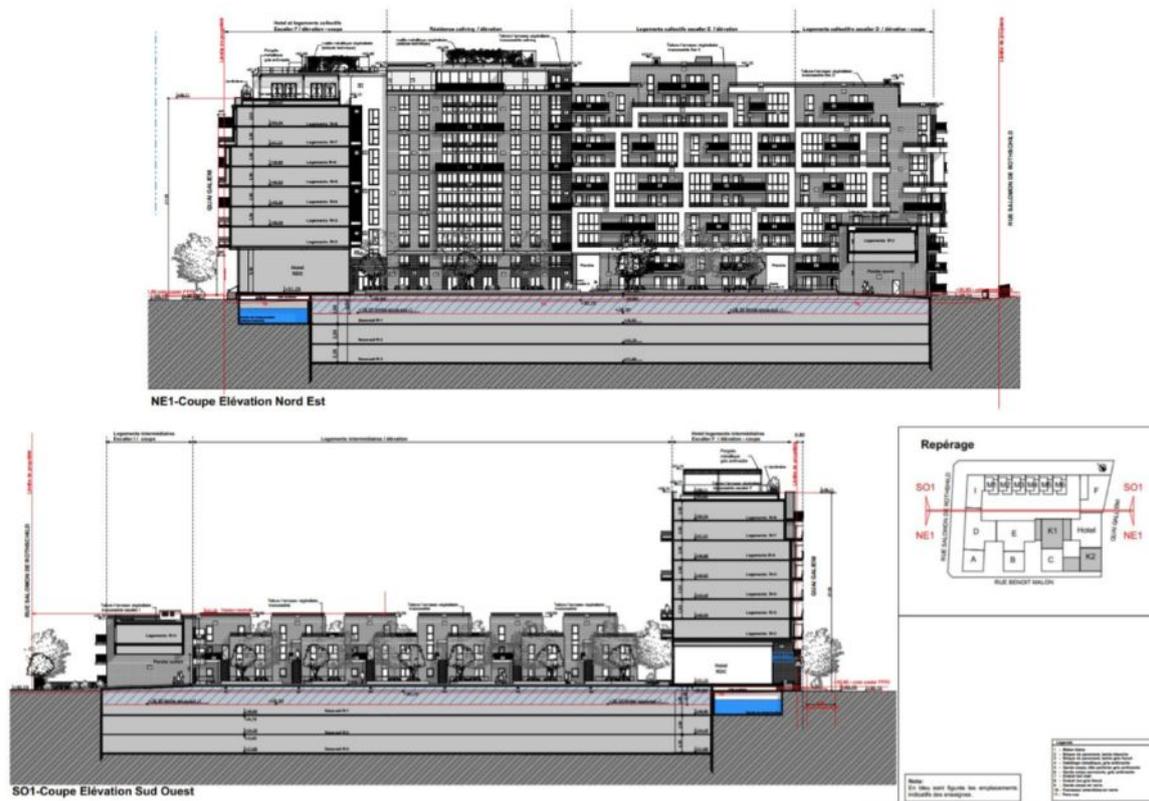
Plans et coupes de façade du projet (source : étude d'impact)
